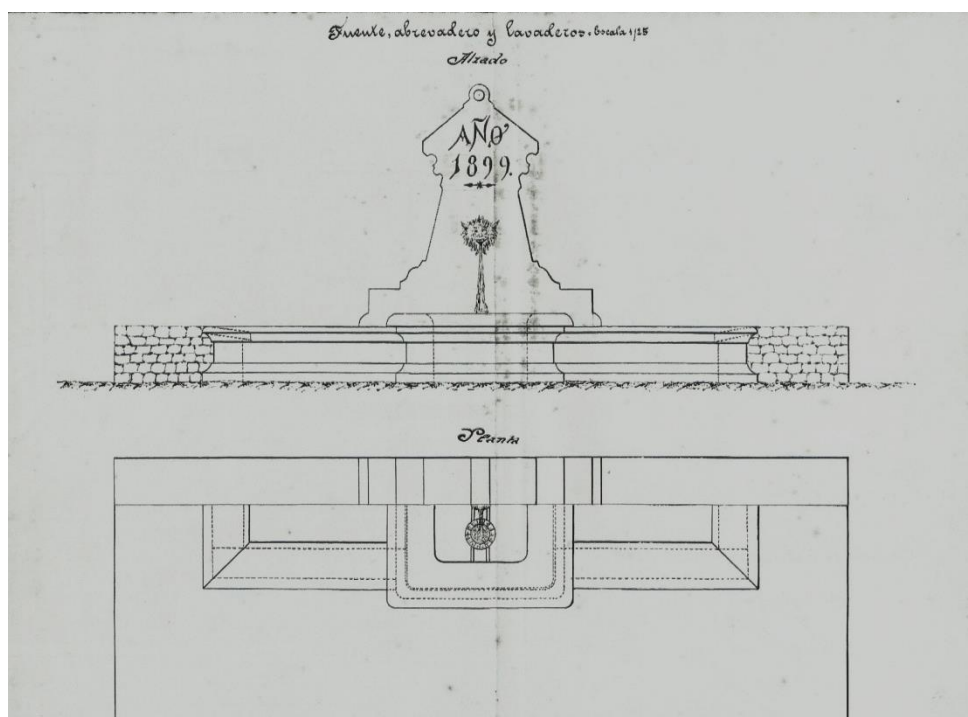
Proyecto de Fuente, depósito y lavadero de La Piperona. Alzado y planta. Ayuntamiento de Mieres. 1899. Archivo Municipal de Mieres
